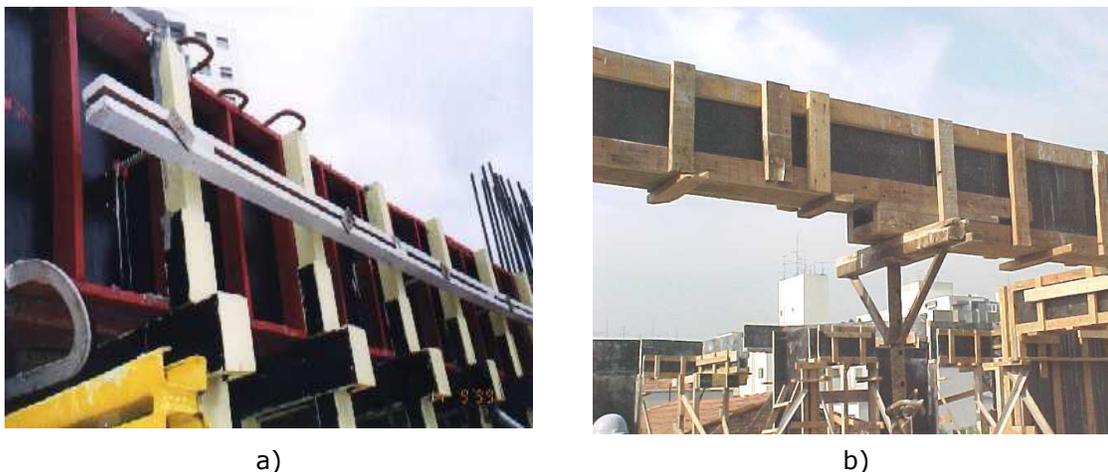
Fôrmas de viga: a) Painéis estruturados com sarrafos, travamento com viga sanduíche e barras de ancoragem, além do prolongamento das pernas dos garfos, e escoramento com garfos de madeira; b) Painéis estruturados com sarrafos e escoramento com escoras pontuais com cruzetas.
